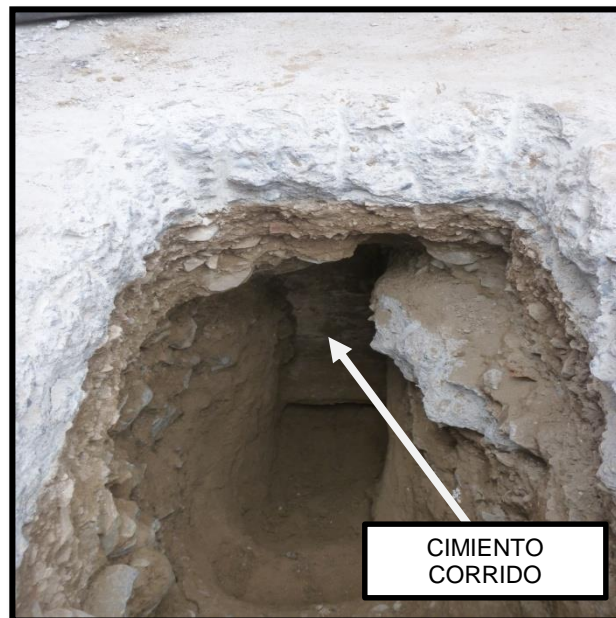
VISTA DE LA AUSCULTACIÓN N° 5.
